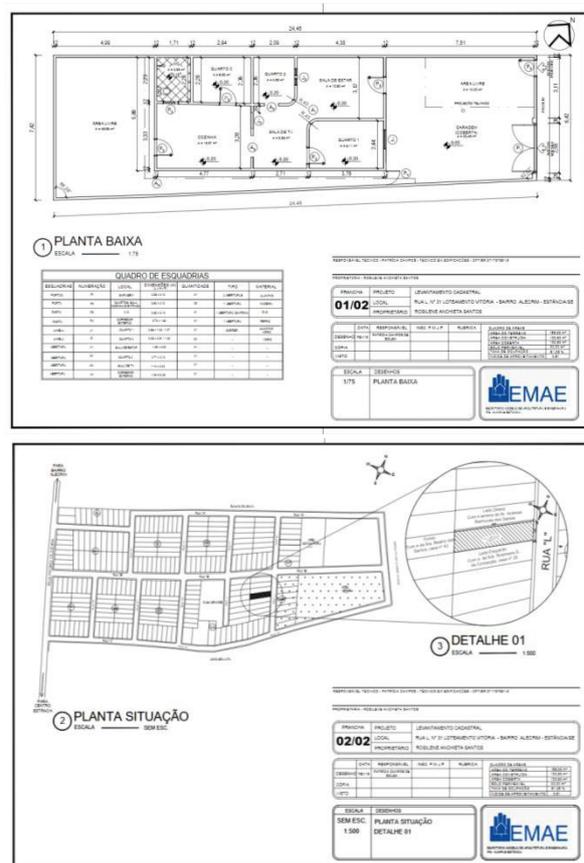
Exemplo de planta baixa e planta de situação de um dos beneficiados do EMAE I
